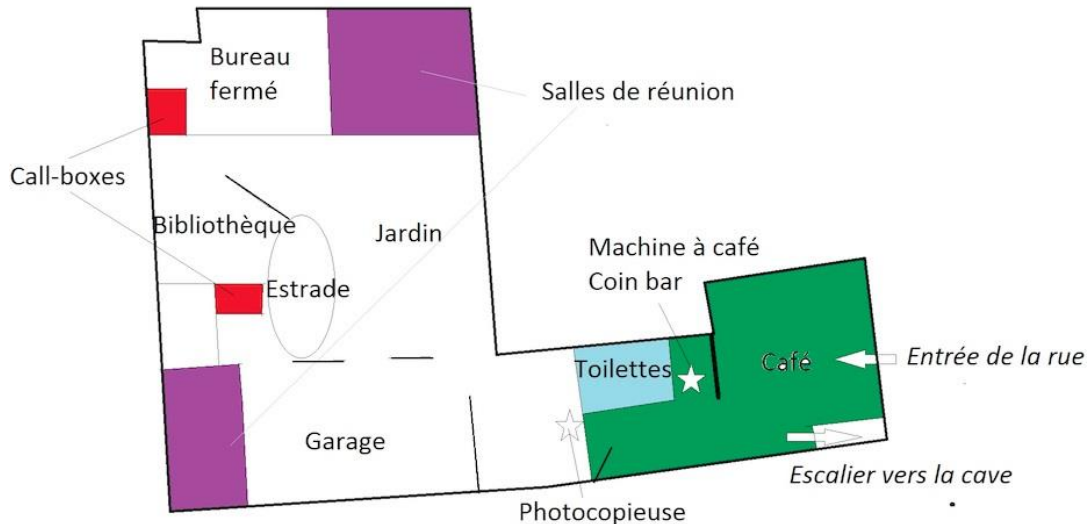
Plan de Mutinerie (source : auteur, adapté à partir de plans de Mutinerie disponibles sur le site internet). Les trois zones de la salle de travail sont séparées par des rideaux ou des poteaux qui les isolent visuellement tout en gardant une unité de l'espace. Le bureau fermé et la salle de réunion attenante sont séparées par des vitres transparentes.
